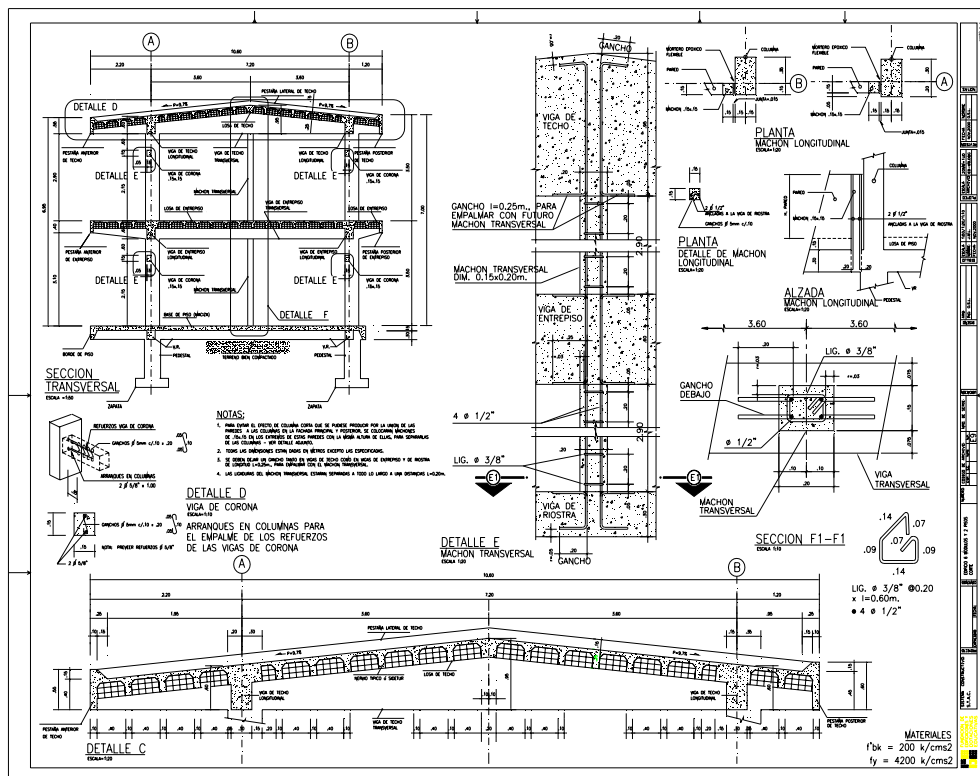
Cortes y sección transversal. Tipo STAC
